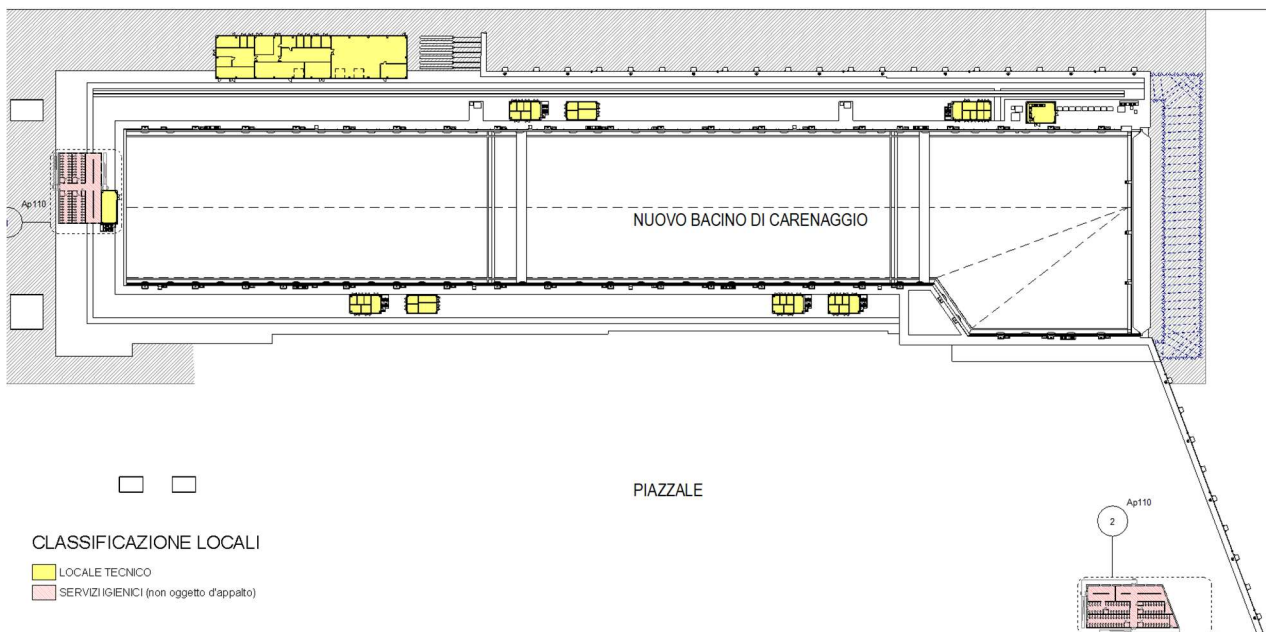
Planimetria inquadramento fabbricati – Opera C
